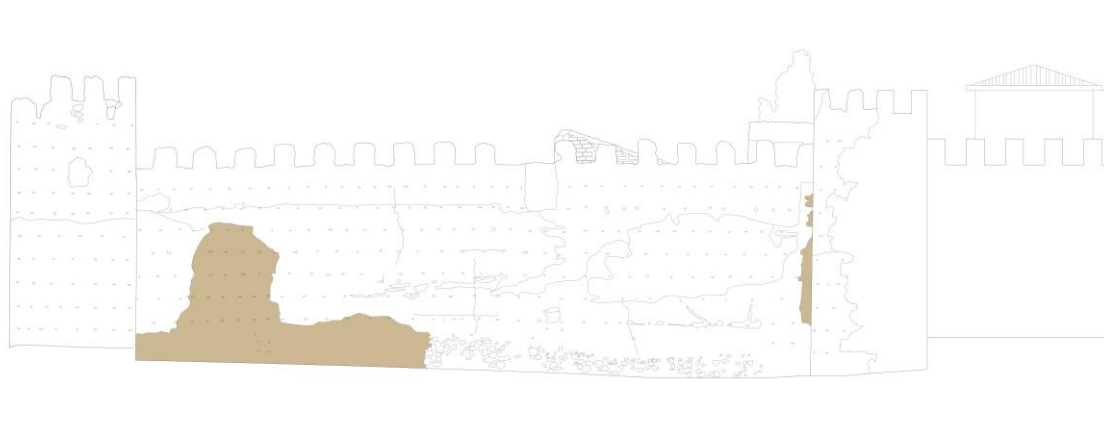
Alzado Norte con mortero de cal en el lienzo 1. Escala 1/200. Fuente: Autora.
